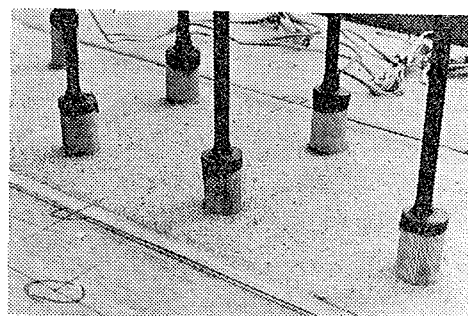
打継ぎ面と結合鉄筋 (ゴムホース付き)
